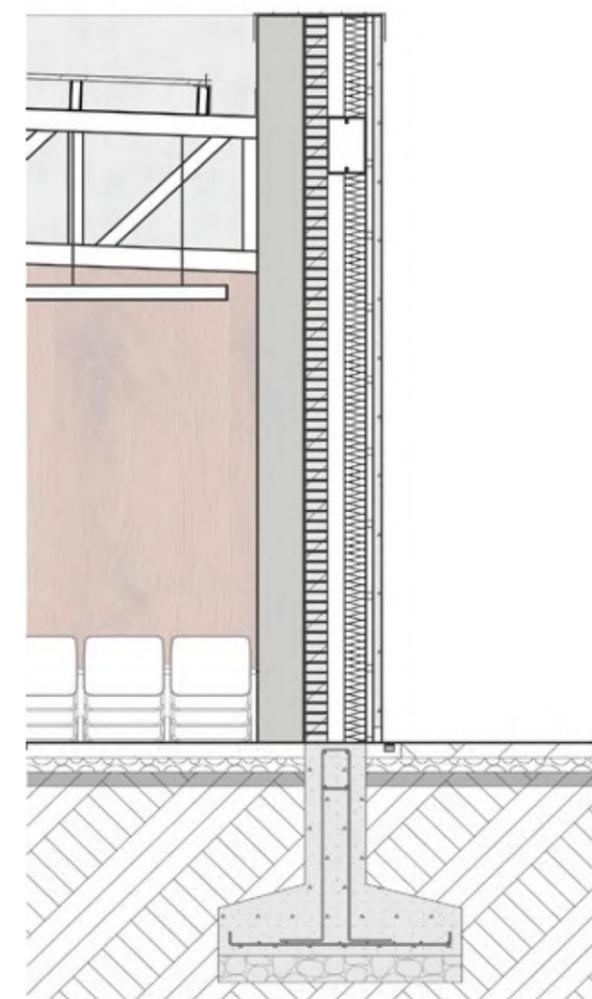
| Elevación, sección y detalles auditorio | Fuente: Elaboración Propia
